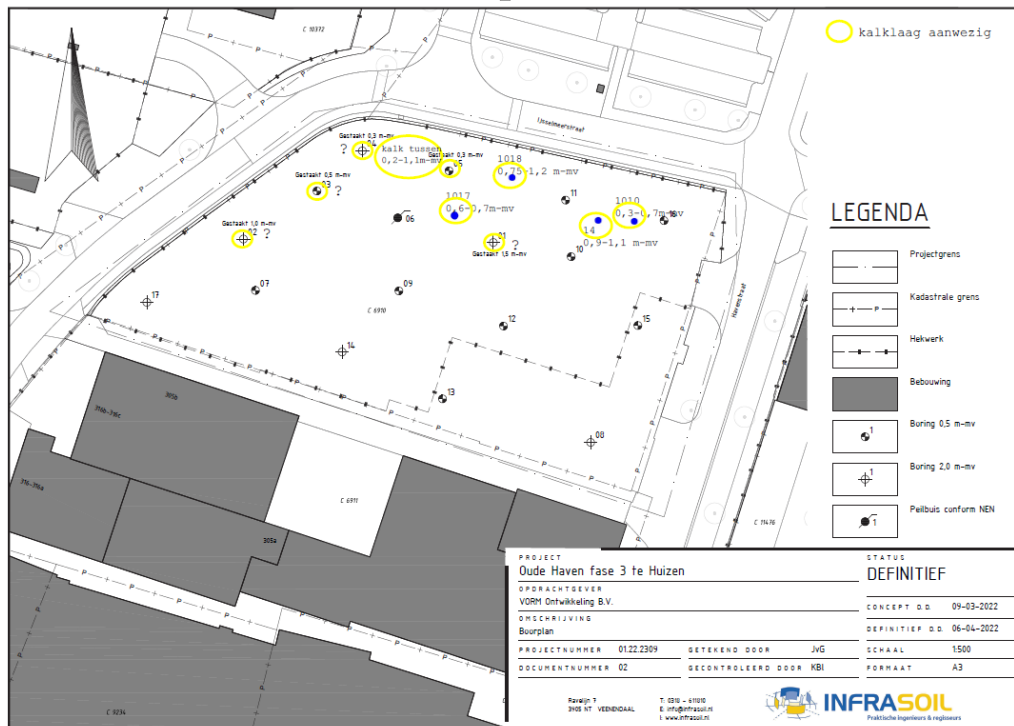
Boorpunten bodemonderzoek in stedenbouwkundig plan.
